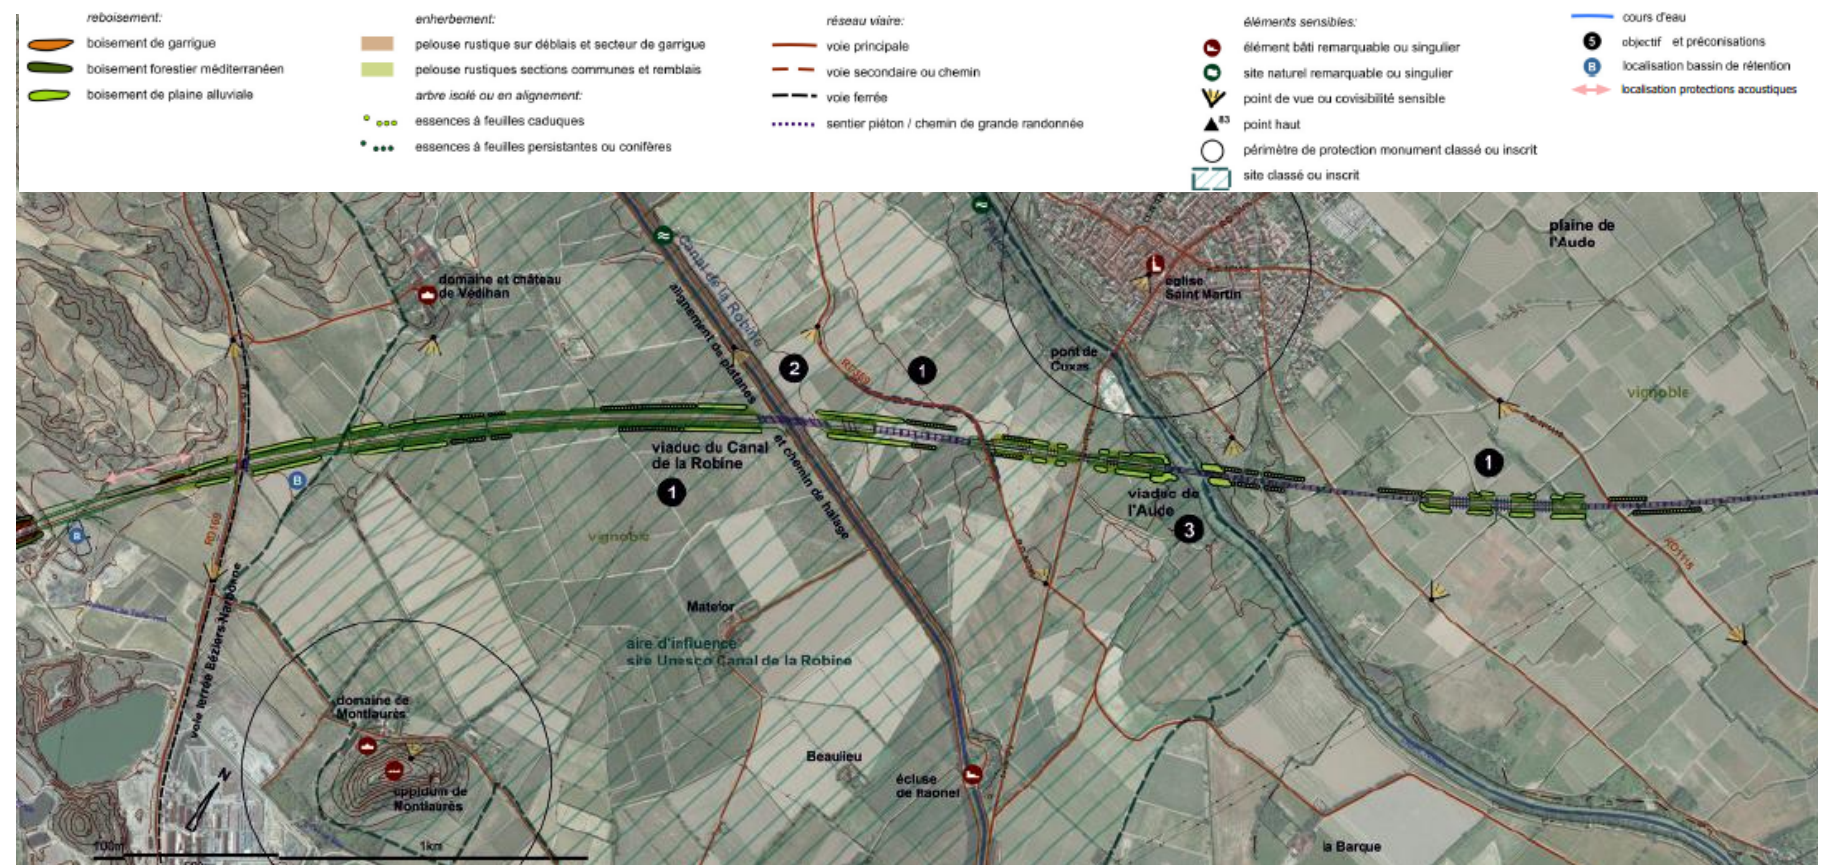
plan des mesures paysagères dans la traversée de la plaine de l'Aude et du Canal de la Robine (source : Traverses)
